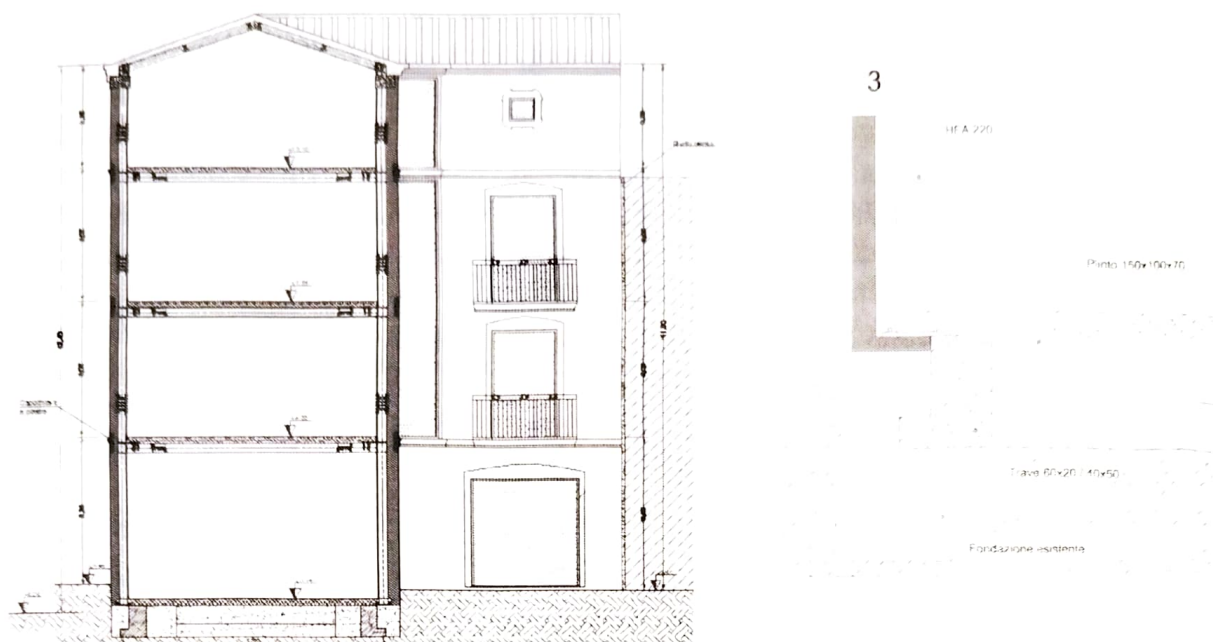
A) Sezione; B) Particolare sottofondazione
